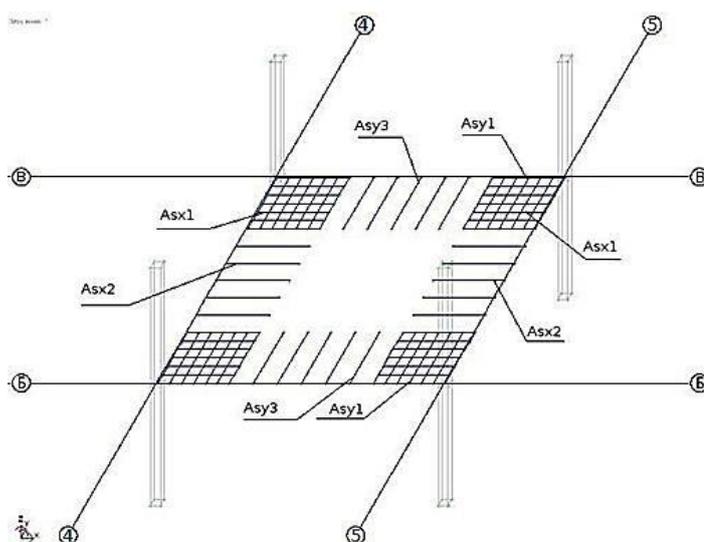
Схема верхнего армирования плиты перекрытия
